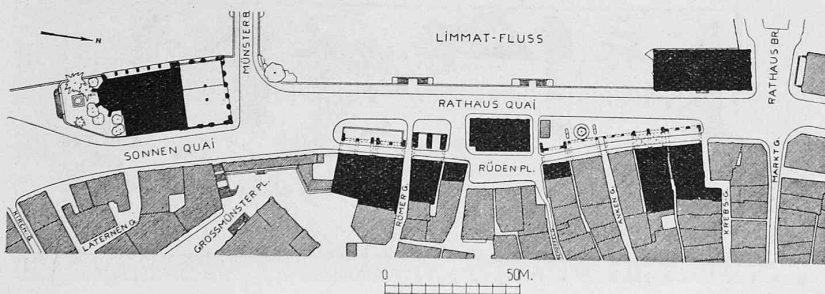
Rathausquai mit dem „Rüden“ (in der Mitte, vorstehend). — Lageplan 1 : 2500.
